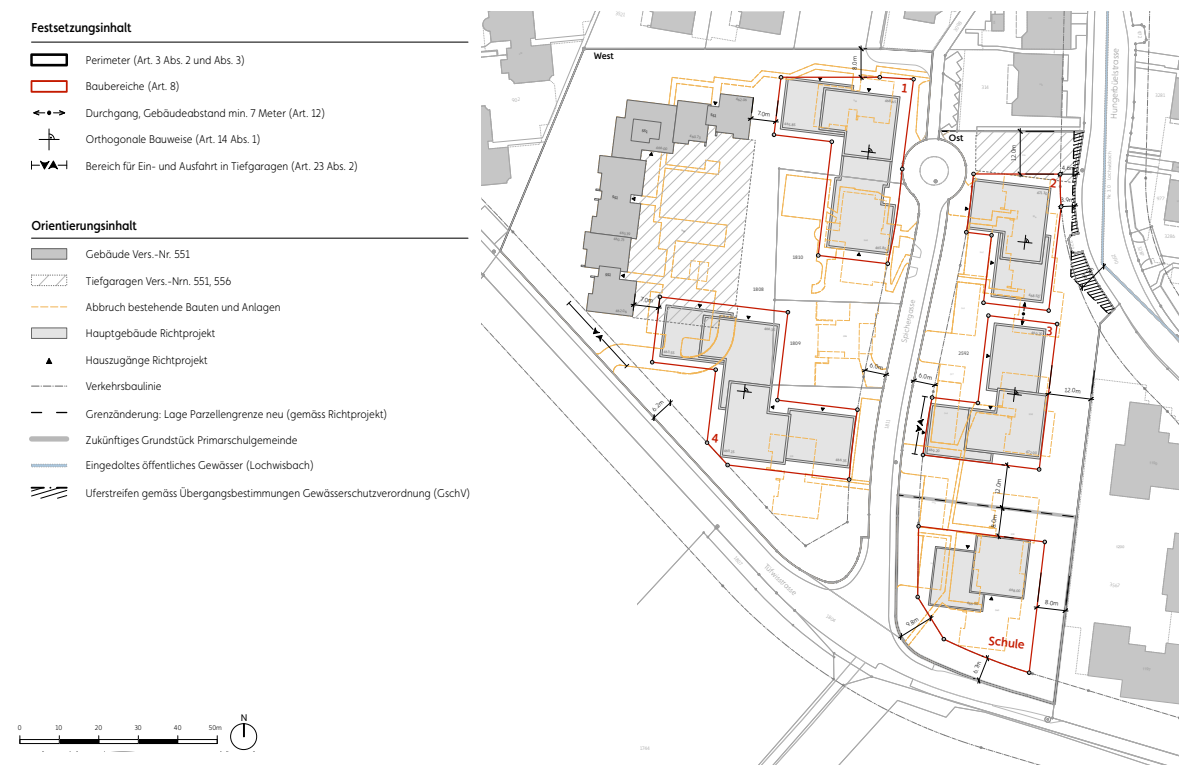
Ausschnitt Situationsplan (verkleinert)
